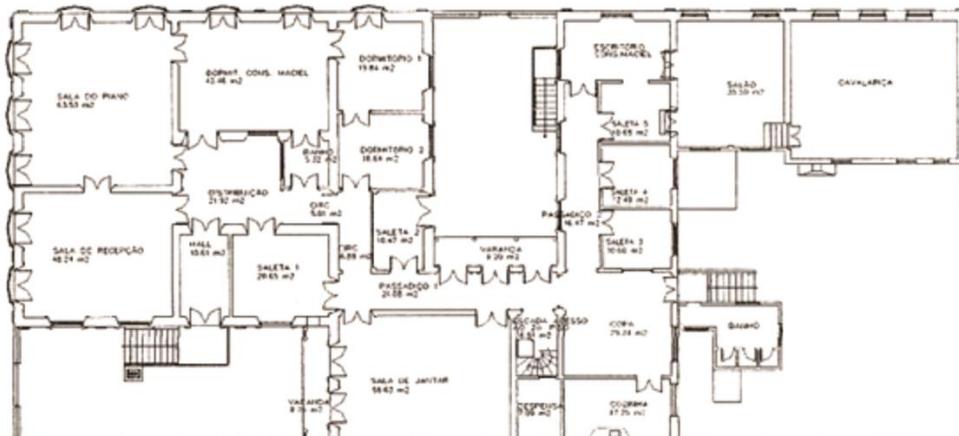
Croqui da planta baixa do Casarão 8 (Fonte: Peres, 2008).
